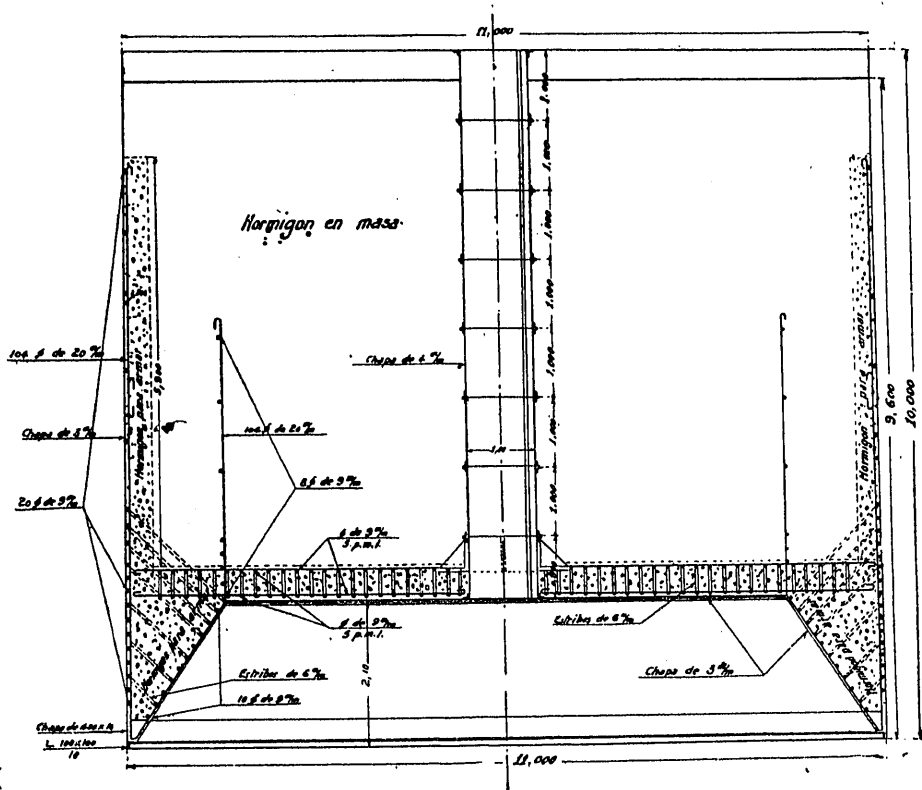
ª Corte longitudinal del cimmento de la pila 1.ª.
